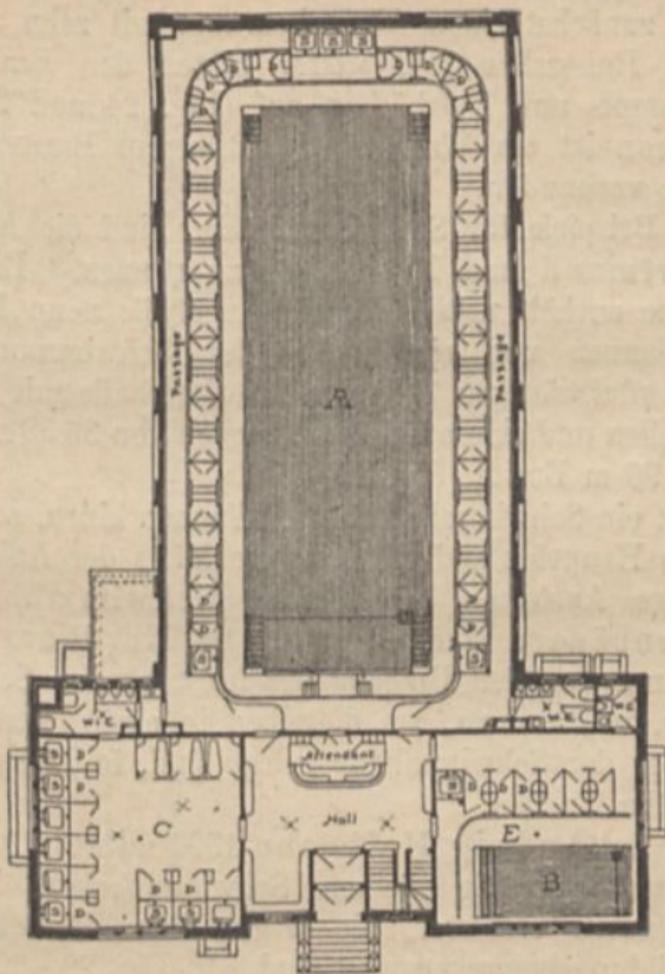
Öffentliches Bad in Brookline: Grundriß.
